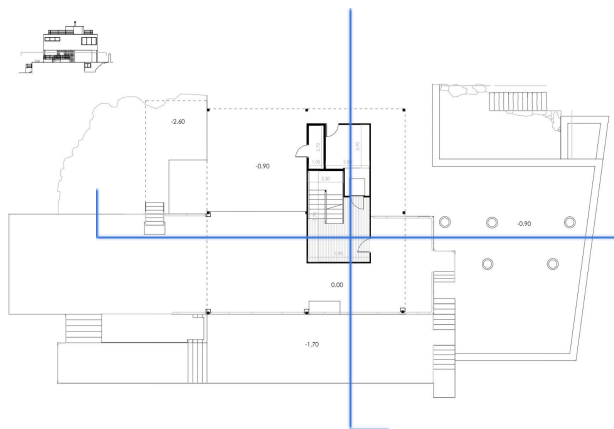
Planta baja o de acceso a la vivienda. Fuente: ver cita 17
